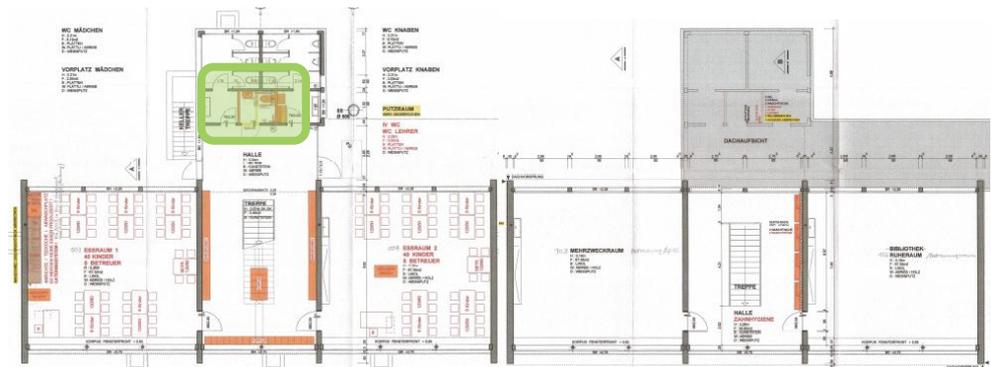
Grundrisse Tagesstruktur Wasgenring (Basel-Stadt)
